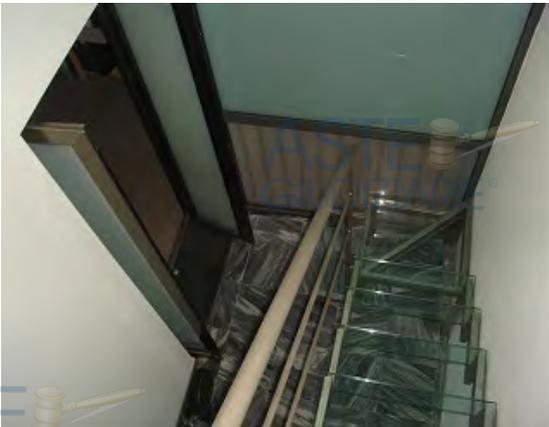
Scala interna di colleg.to piano 2° e 3°
